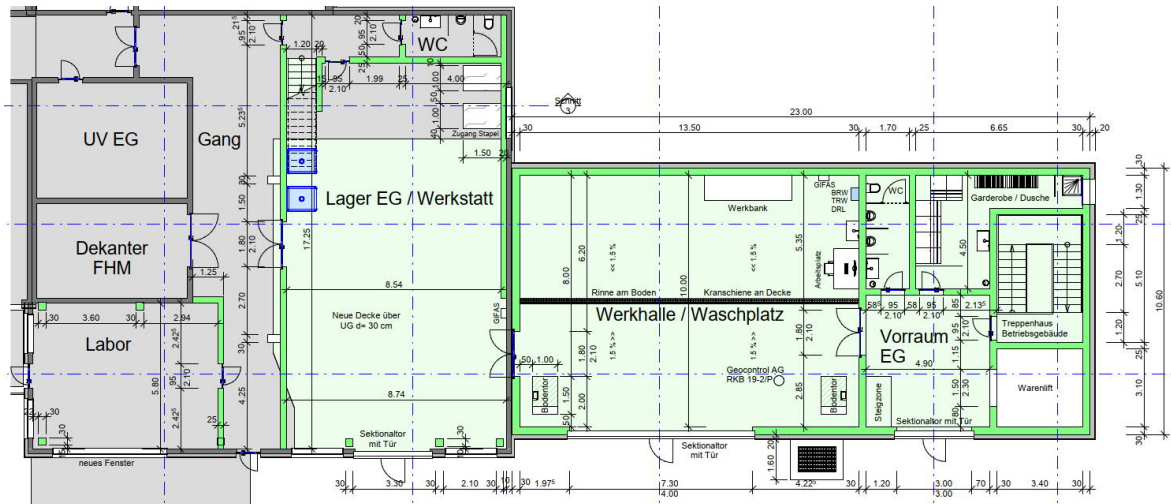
Erweiterung Betriebsgebäude; Planausschnitt EG
